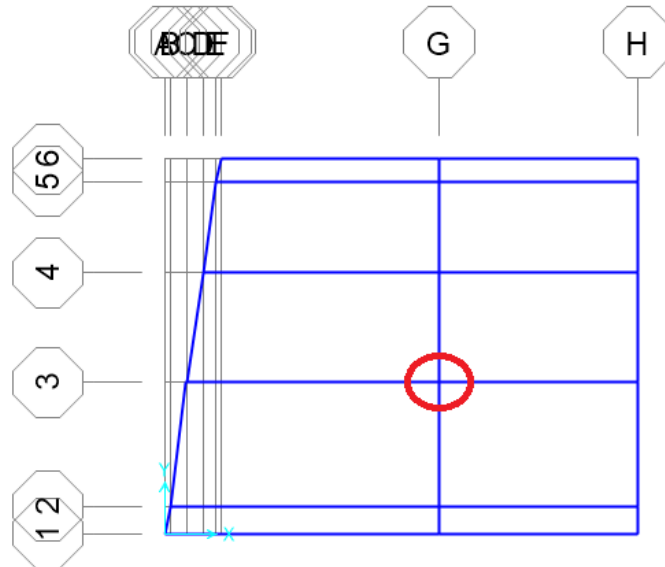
Kolom yang Ditinjau di Bangunan B.1
